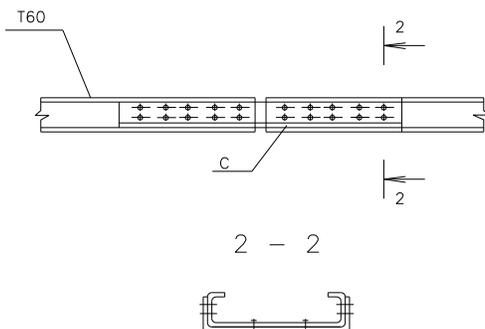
Соединение нижнего пояса ферм при помощи «вставок»
